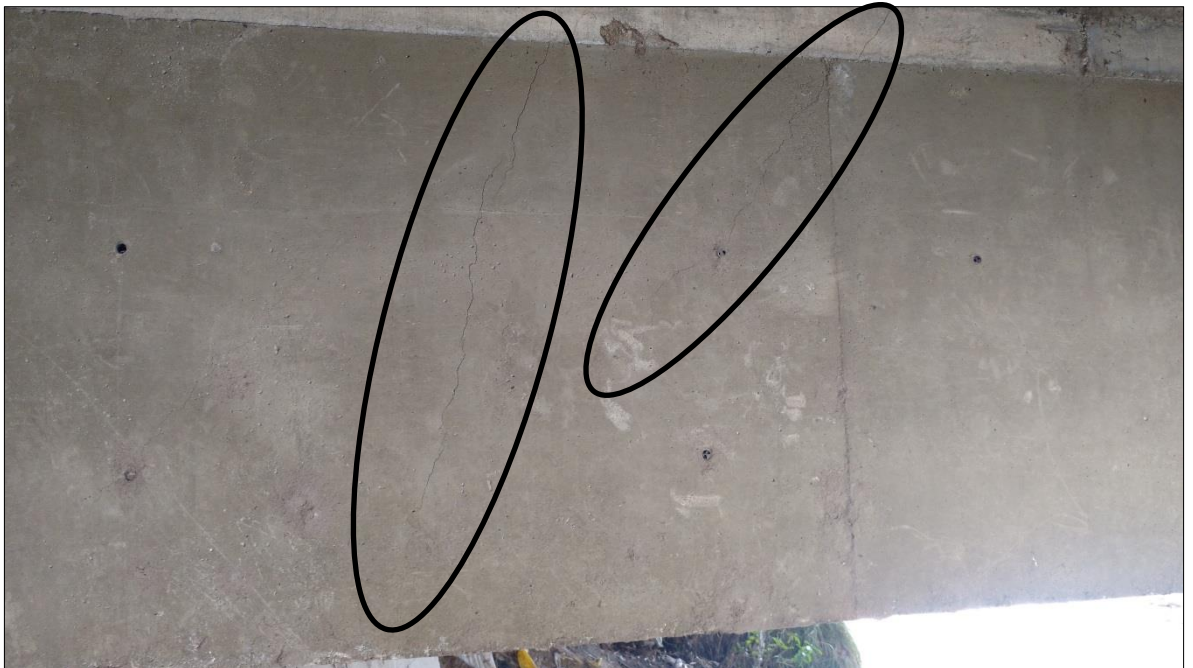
Oxidación - grietas en Tablero y Apoyo
